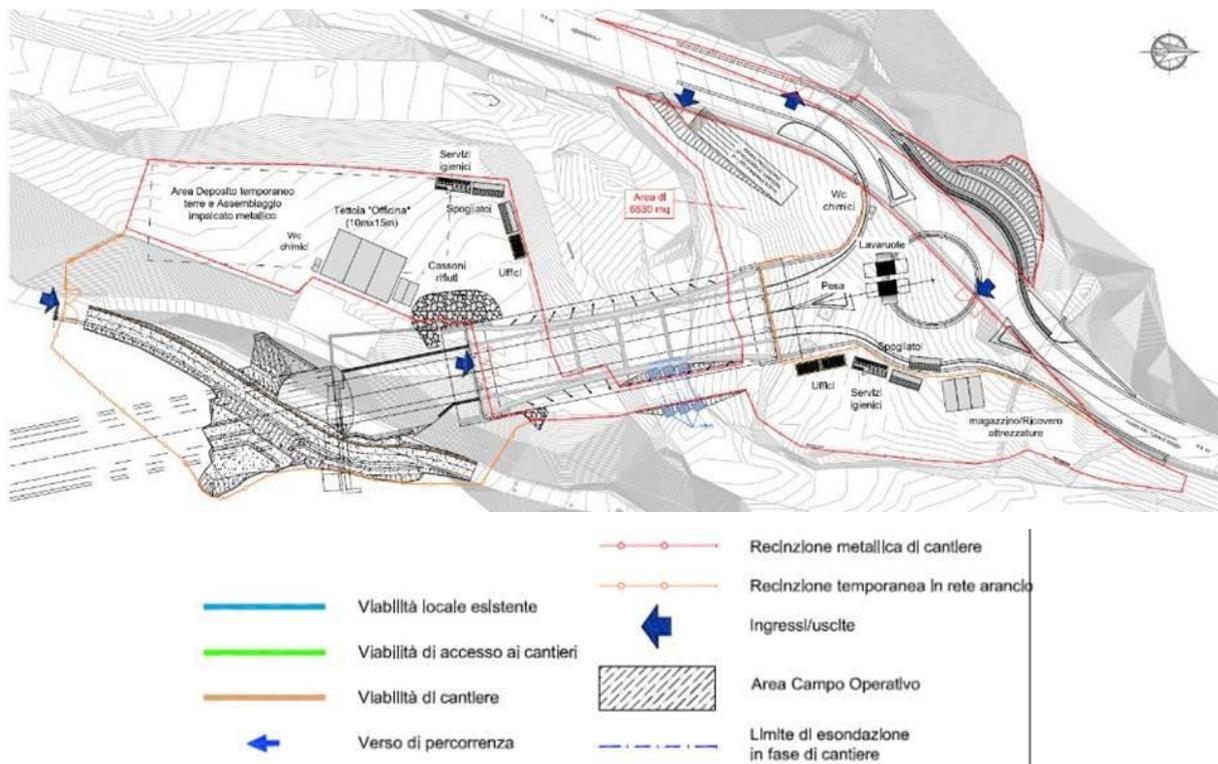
Campo operativo n. 2 (Nord) – Planimetria
